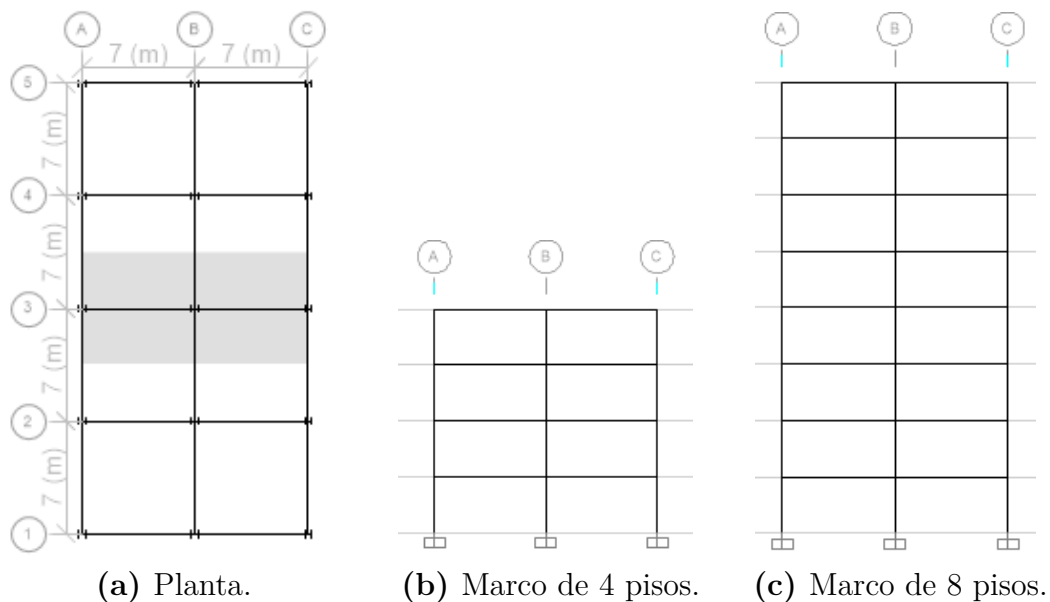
Planta y elevaciones de las estructuras a analizar.
